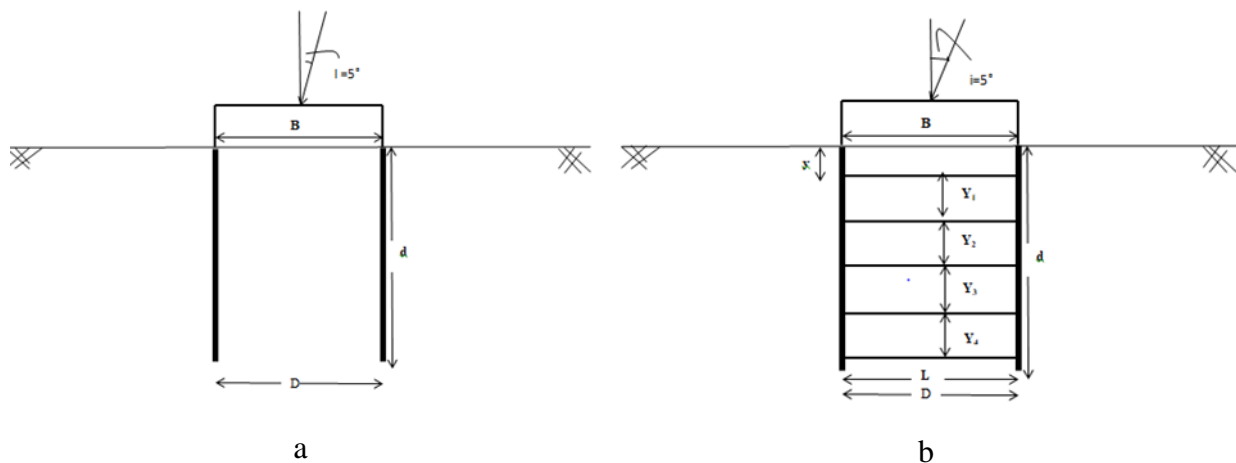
Présentation schématique d'une fondation carrée avec (a) confinement
